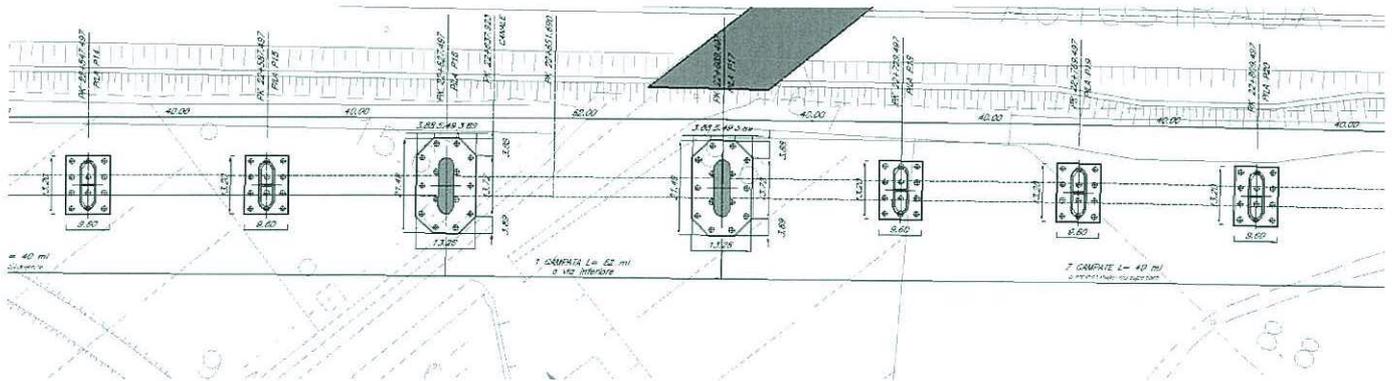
Pianta dell'attraversamento principale con campata L=62.0m.
